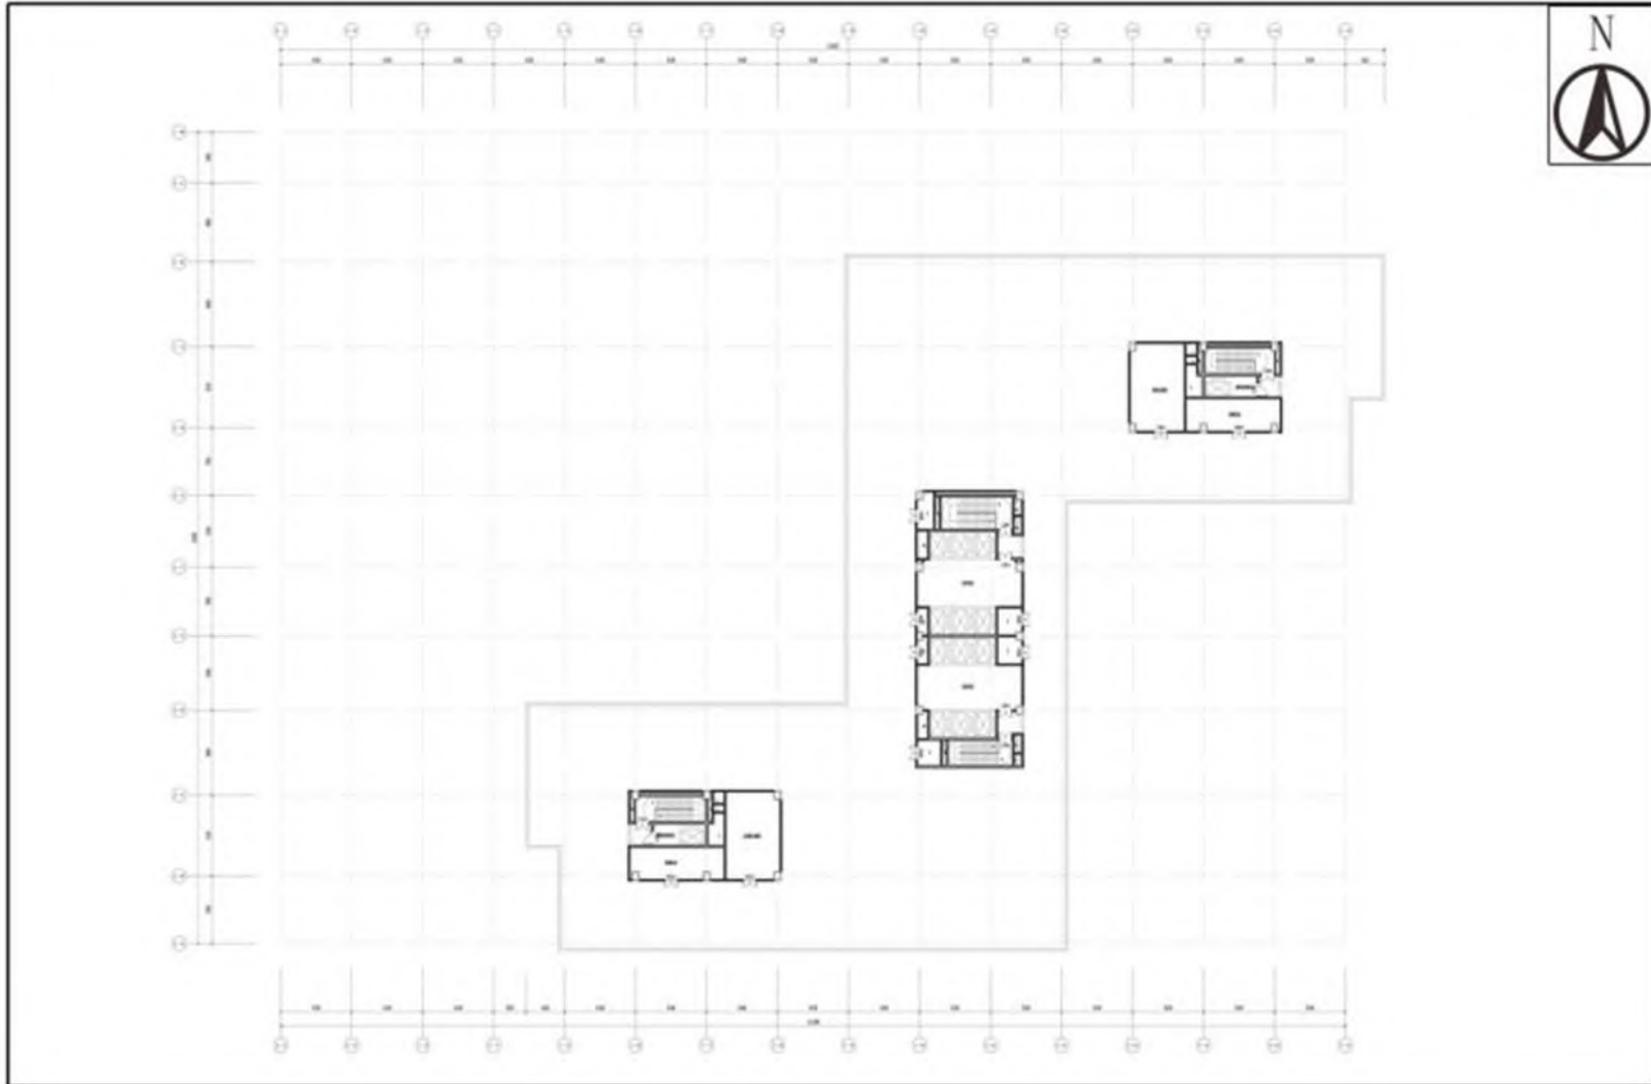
本项目医技病房楼屋顶层平面布置图
